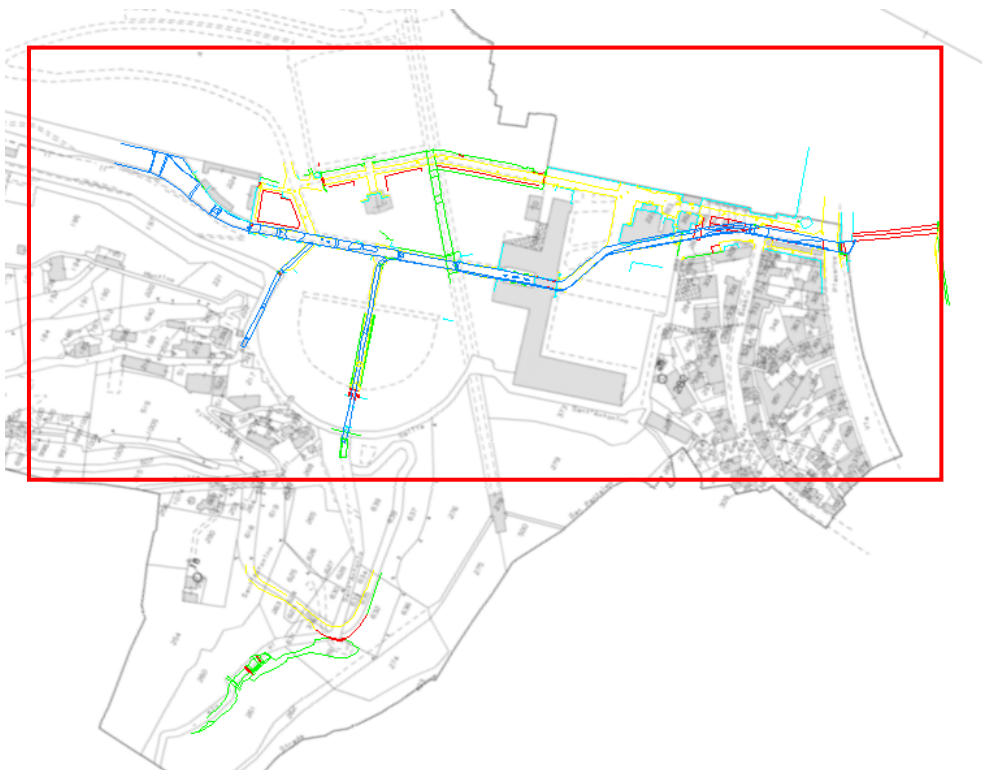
Stralcio planimetria catastale sovrapposta al rilievo
